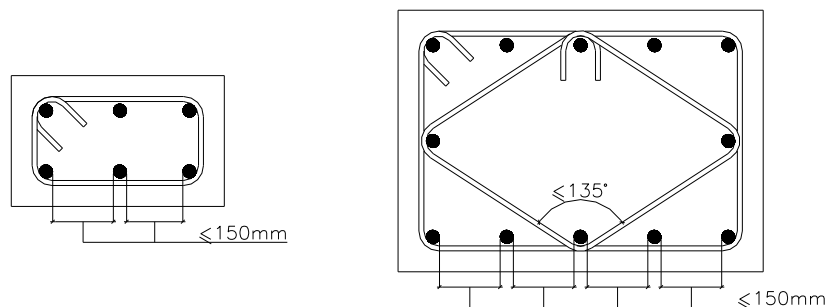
Separación máxima de barras sin apoyo lateral.
